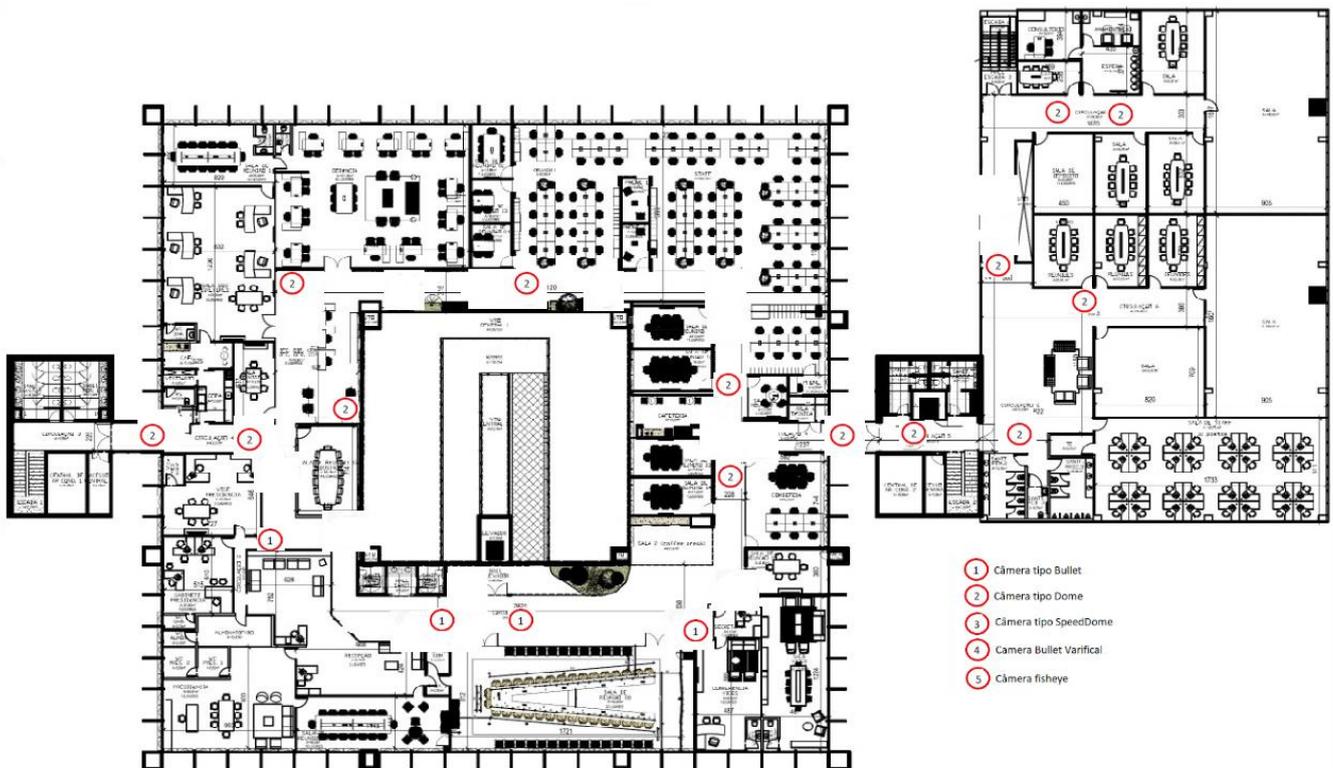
Esboço de posicionamento de câmeras para o terceiro pavimento prédio principal;
